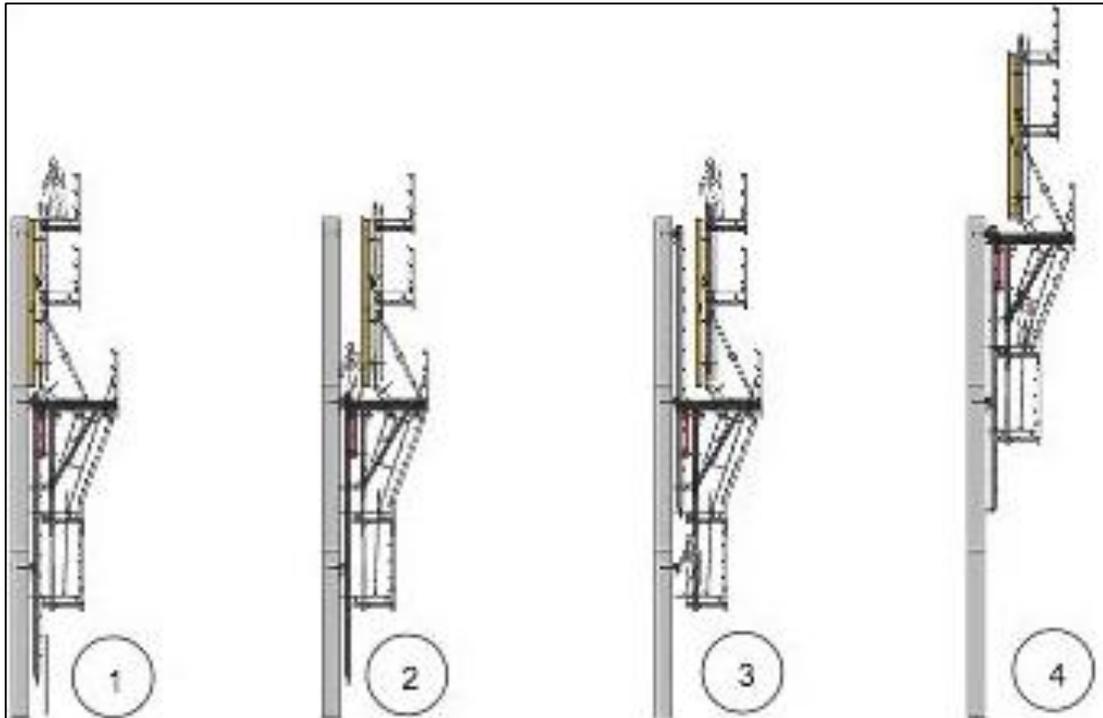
Sistema de encofrado autotrepante - secuencia de trepado.
